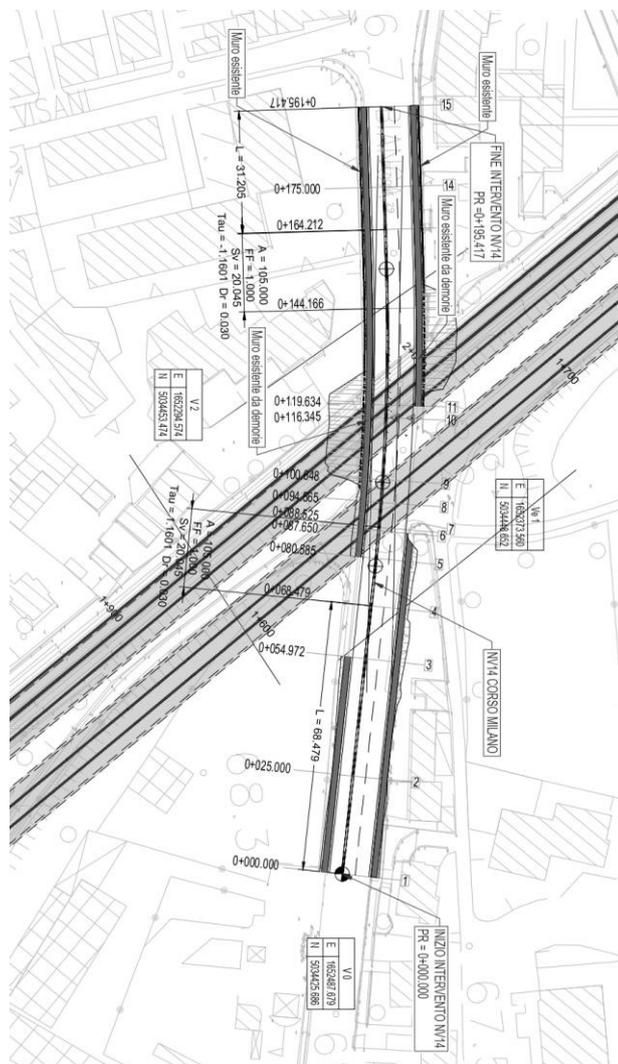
NV14 – Stralcio planimetrico su rilievo Corso Milano
